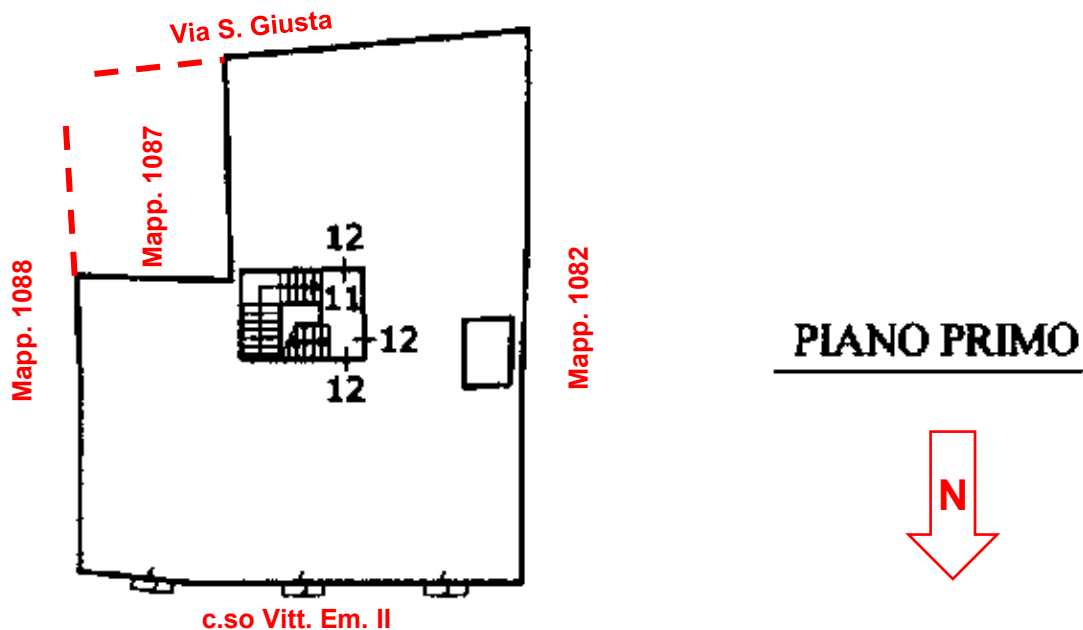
LOTTO 2. Stralcio elaborato planimetrico (fuori scala). Nord in basso
